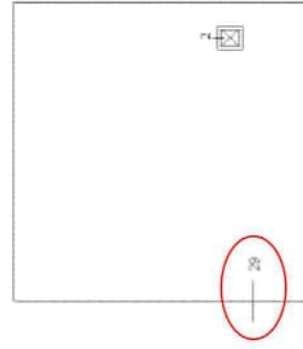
Elaborato planimetrico particella 1016 – Cerchiato in rosso il subalerno oggetto di esecuzione
